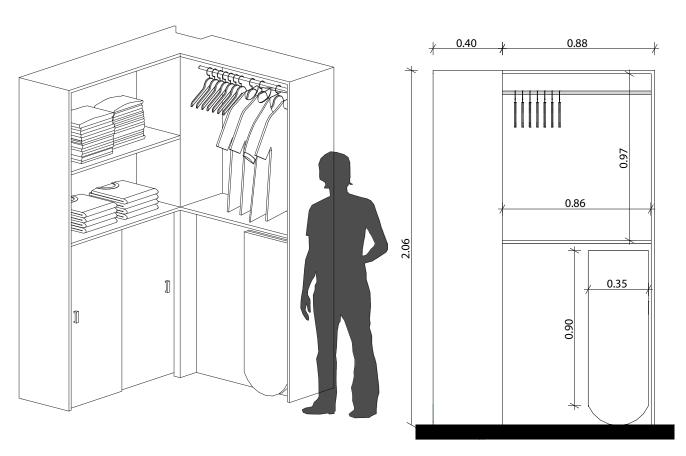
Perspectiva de mueble de planchado cerrado Nota: Elaborado por el autor
